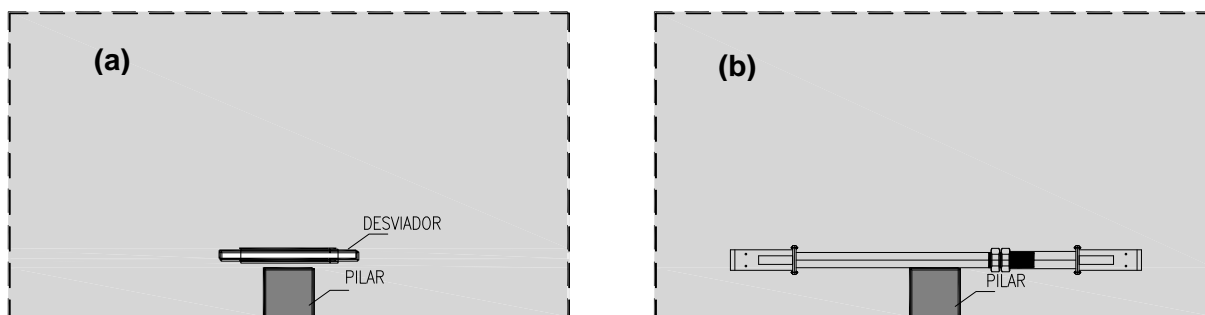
Aplicação do sistema no caso de um pilar de bordo, (a) vista superior e (b) vista inferior.
